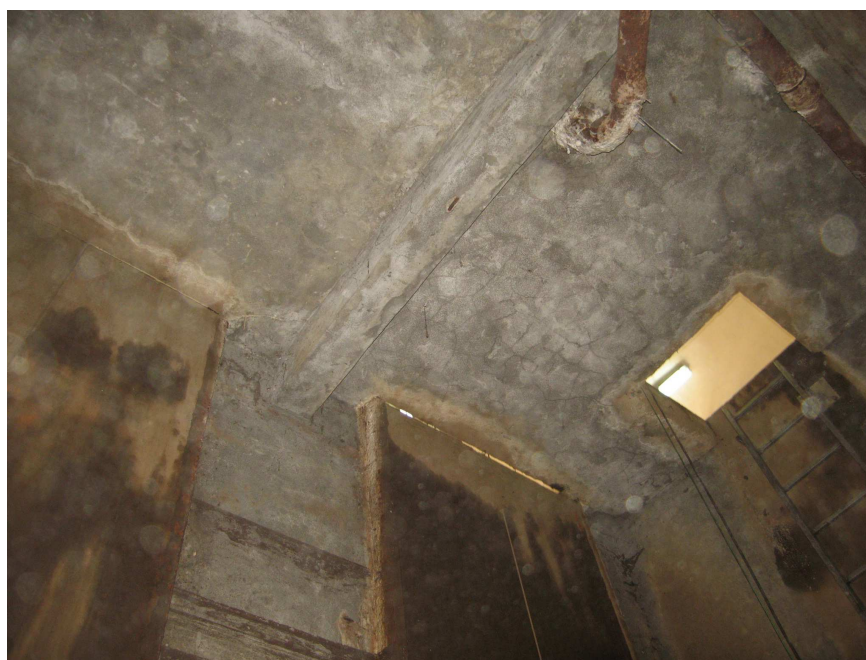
Widok ścian i stropu komory zasuw, kondygnacja -1
